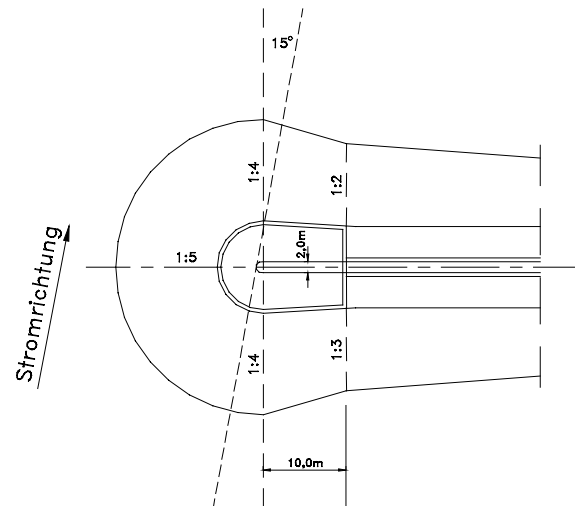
Schematischer Grundriss der Modellbühnen.
